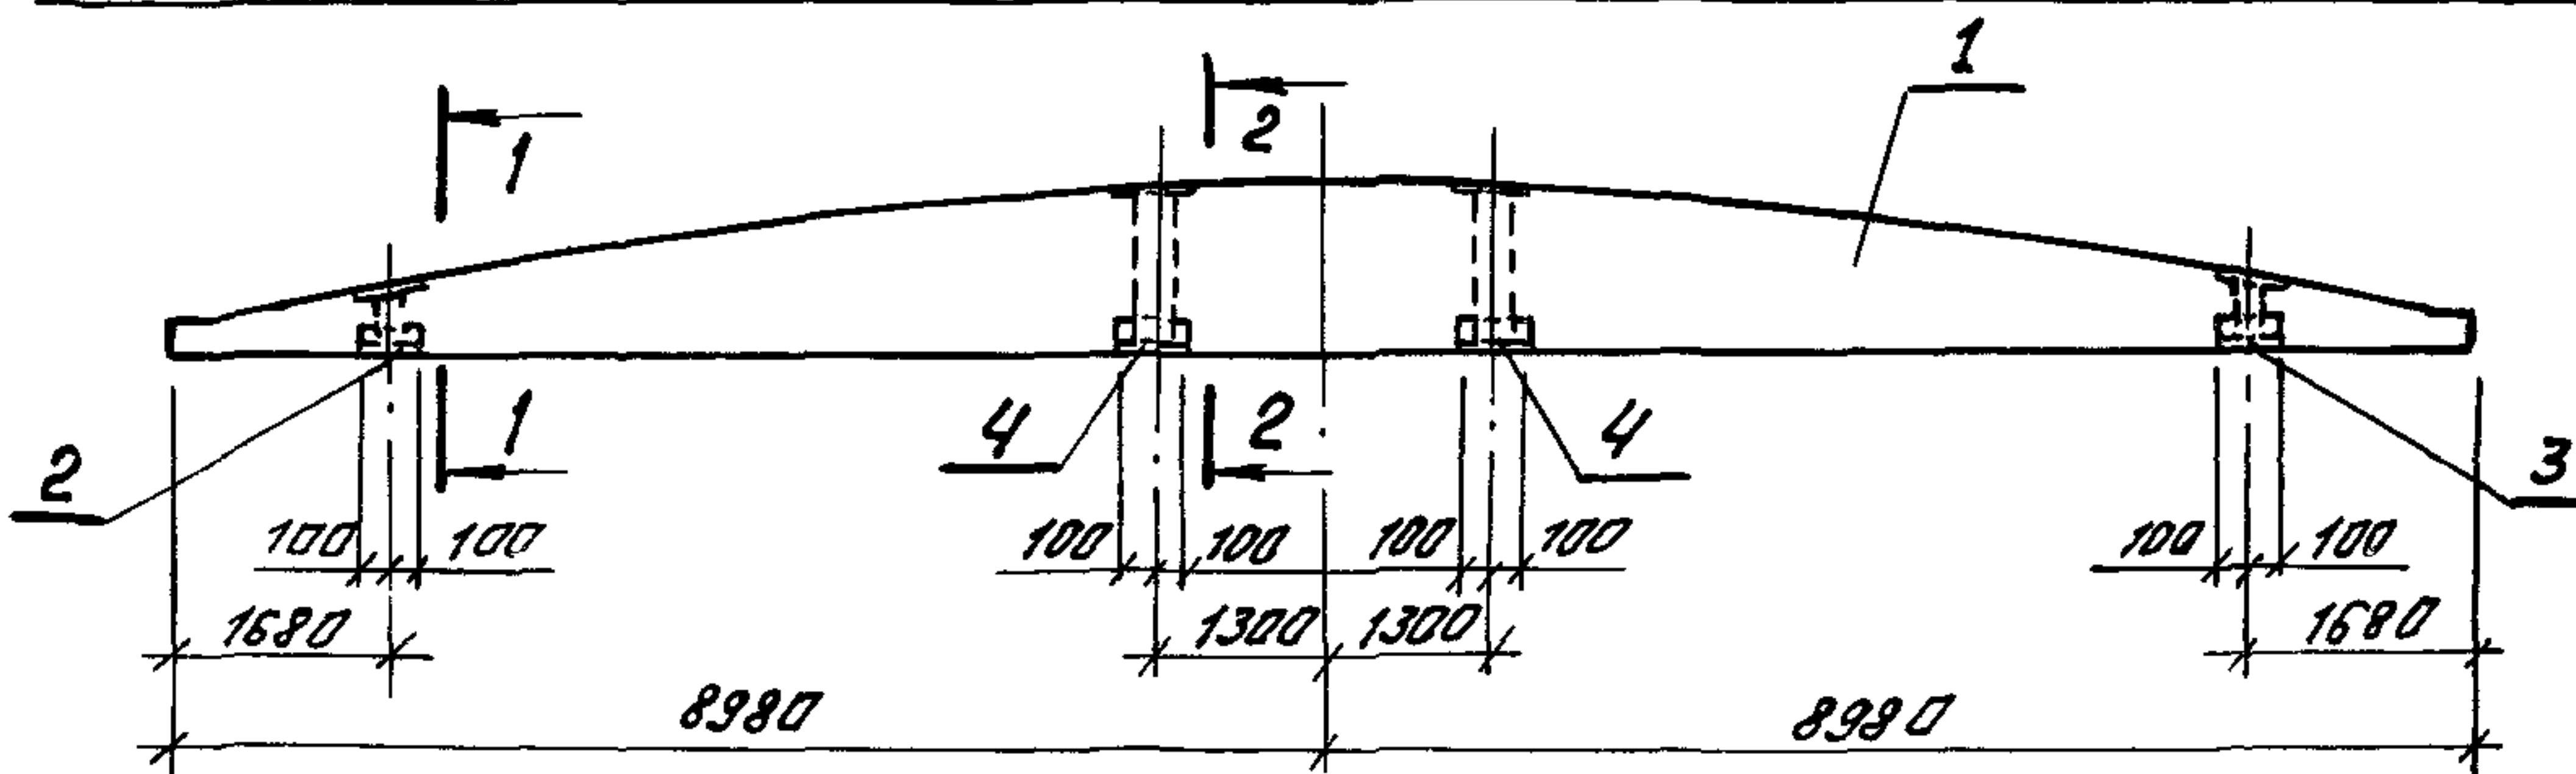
Доработка чертежей плиты 1КЖС 18Г-ЗЛПК-б с закладными изделиями для крепления торцевого фахверка
